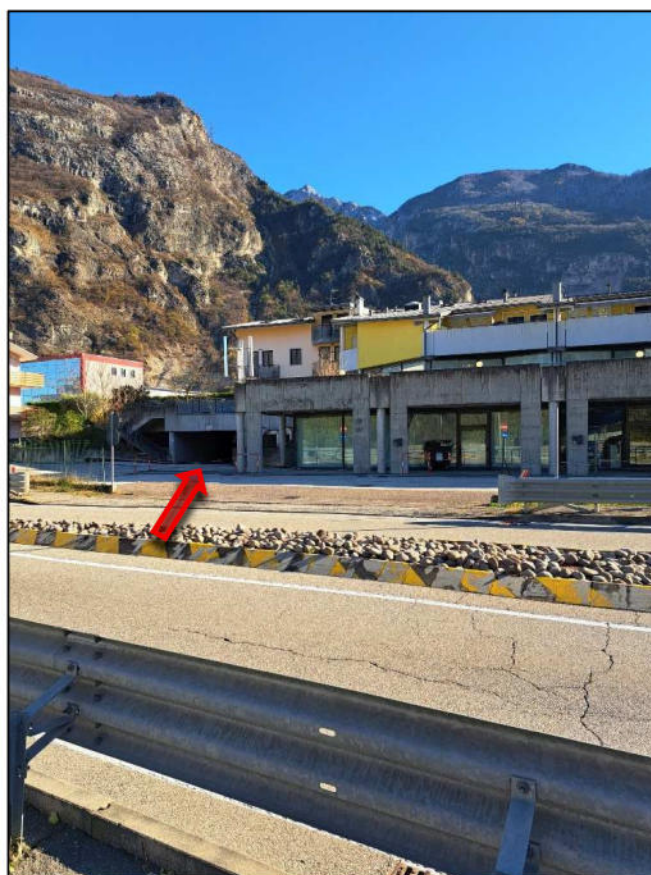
frangente nord del prospetto ovest – evidenza dell'ingresso alle autorimesse.
